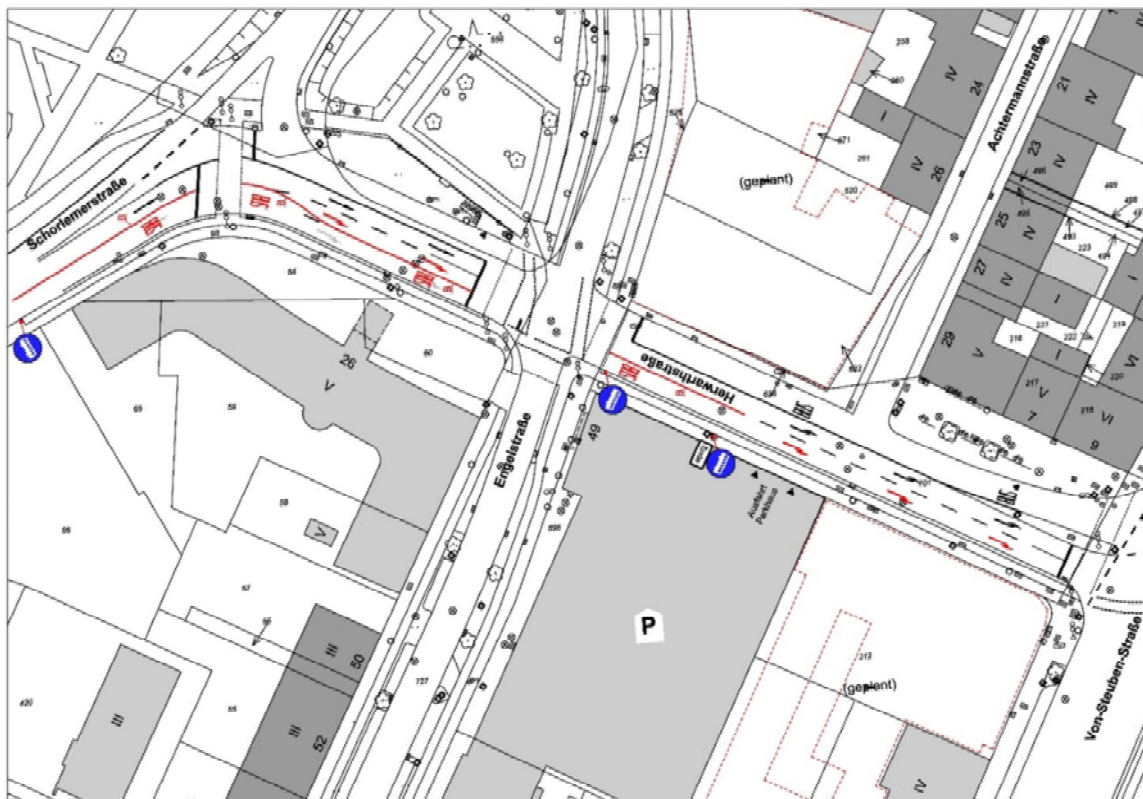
Versuchsplanung Abschnitt Schorlemerstraße – KP Herwarthstraße / Von-Steuben-Straße
